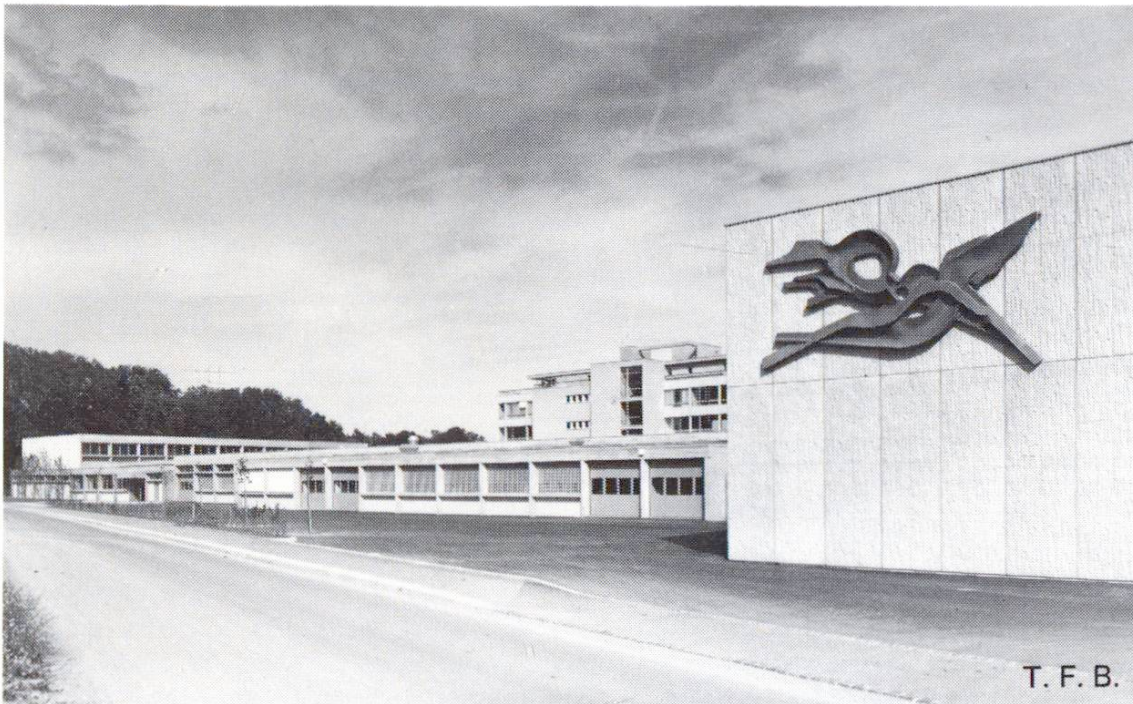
Ecole professionnelle de Colombier. Dalles de façade avec structure «Prewi».
